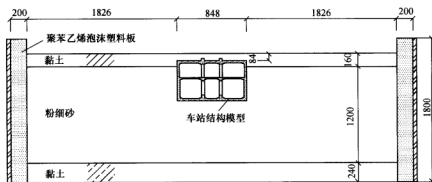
地铁车站结构模型装箱示意图 (单位: mm)
